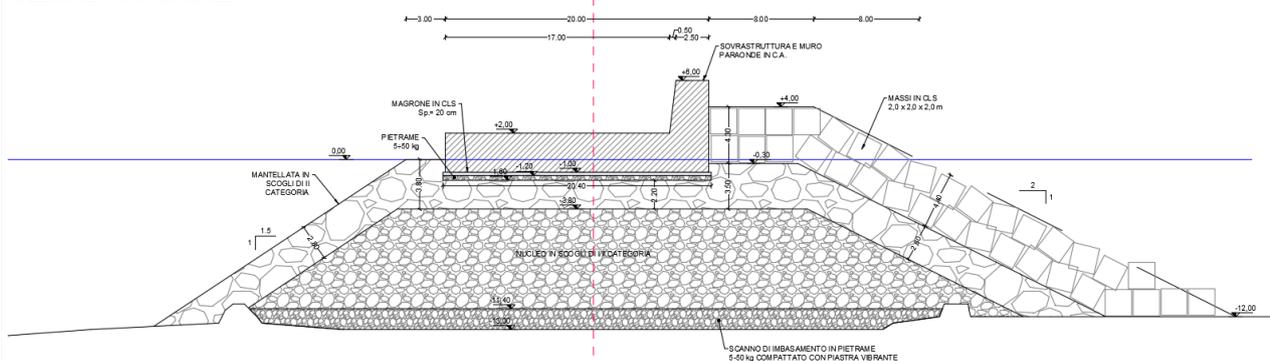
Soluzione di Variante: Prolungamento Molo Sopraflutto – sezione A-A
